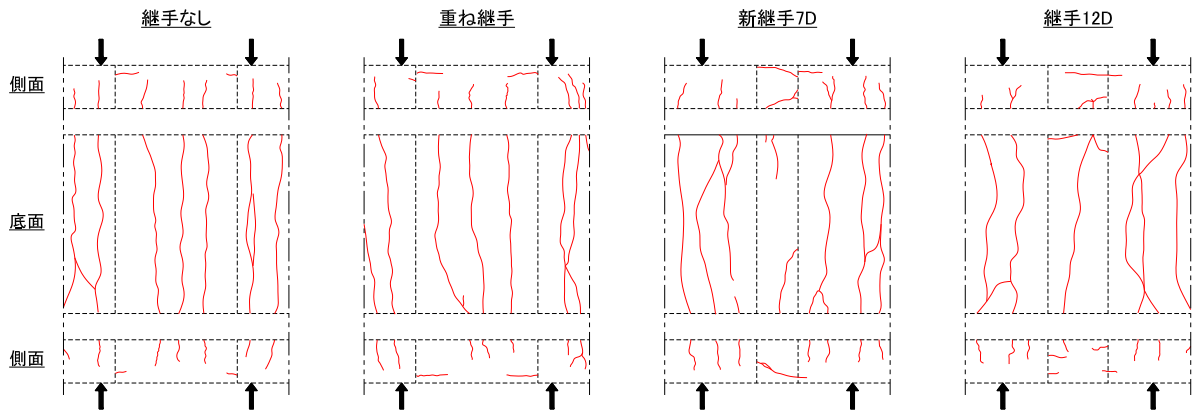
1 破壊後のひび割れ図 (底面および側面)
